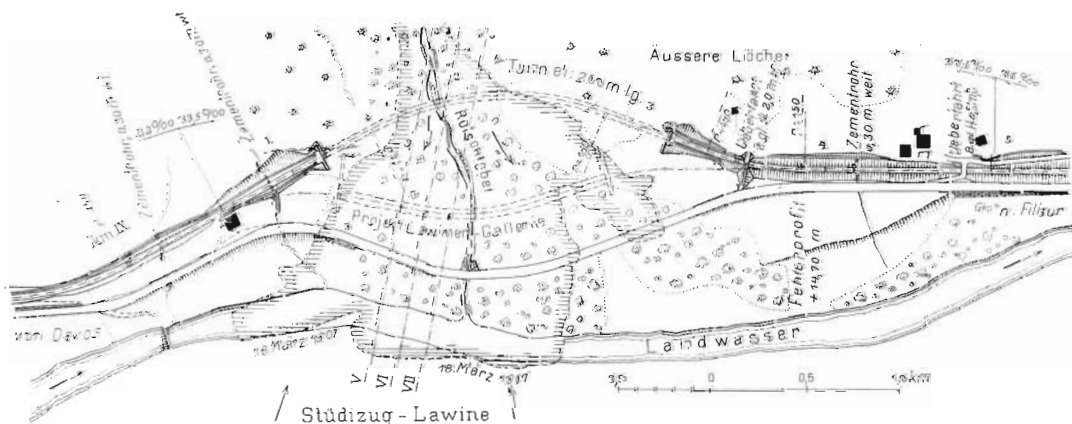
Linienführung im Rutschobel, mit Rutschobel-Lawine vom 18. März 1907. — Masstab 1 : 4000.
